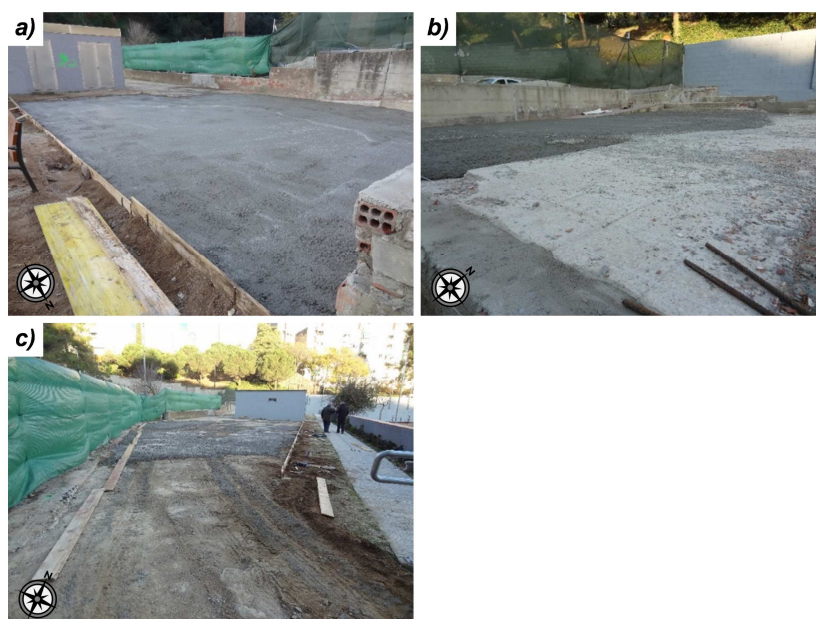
65 – a) losa norte (inferior); b) losa norte (superior); c) losa sur
